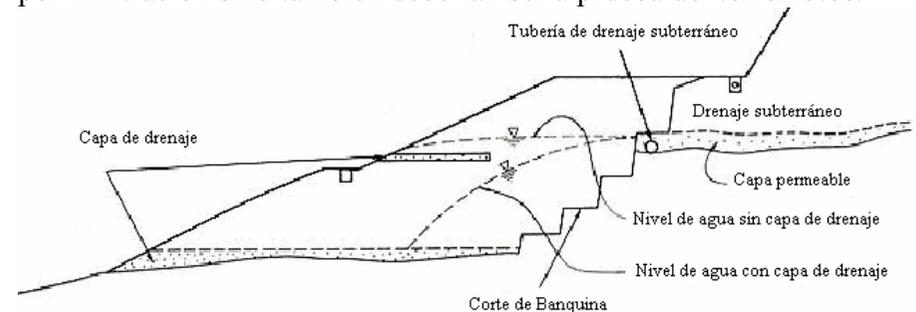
Elementos de Drenaje y Capas de Drenaje para un Talud en Terreno Inclinado
